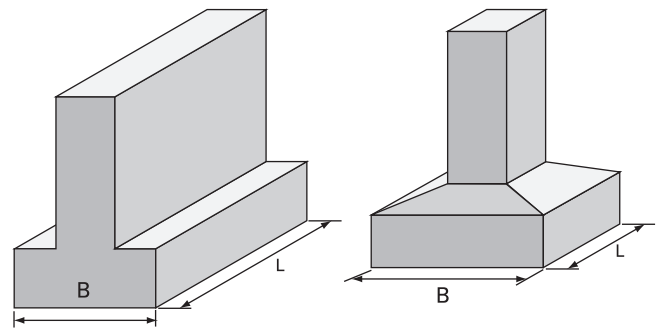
Semelle filante (à gauche) et semelle isolée (à droite)
